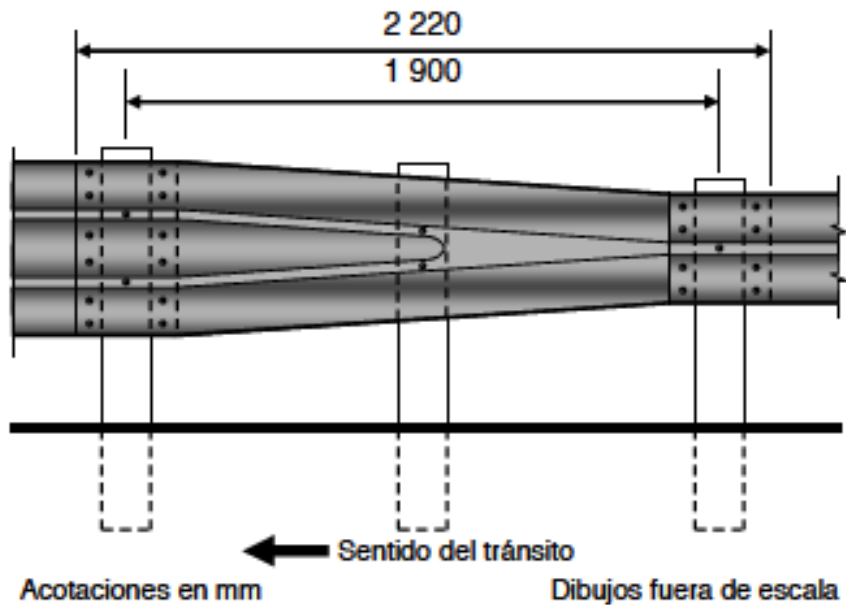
Sección de transición para unir vigas acanaladas de dos y de tres crestas
